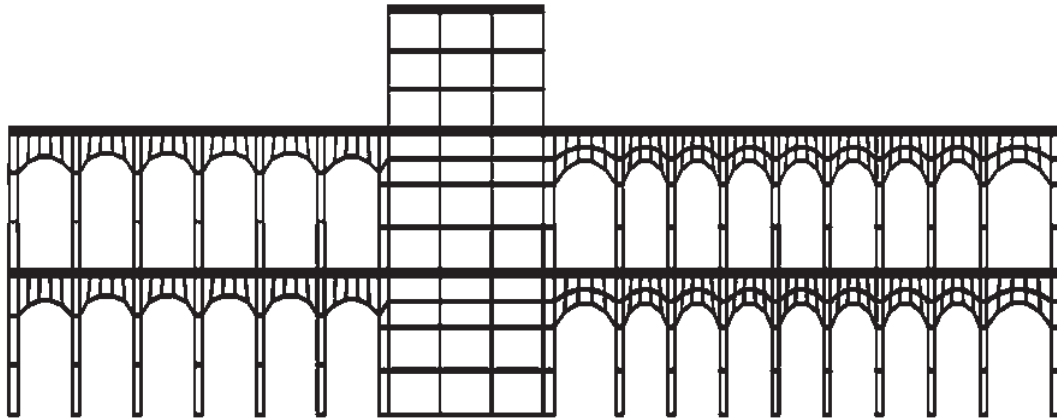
Modelo de elementos rígidos para la arcada Este del primer y segundo patio.
